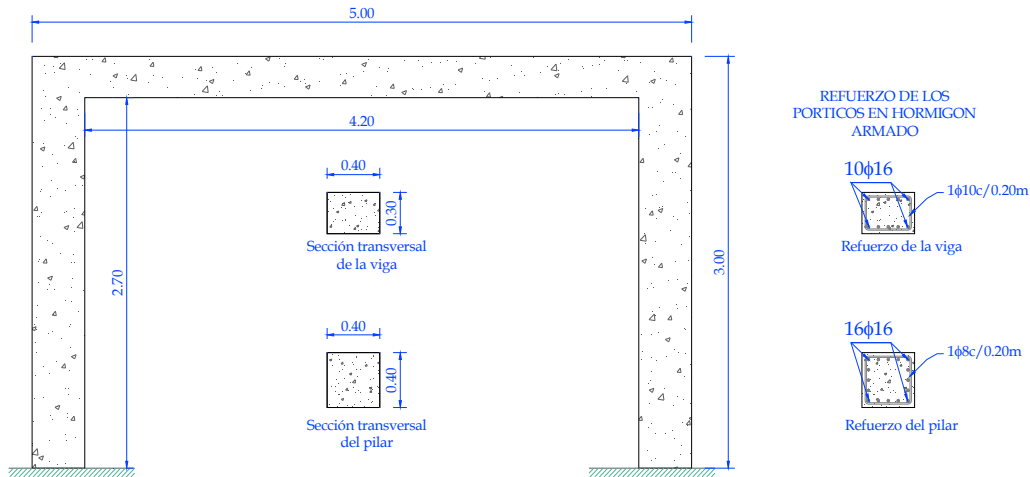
Geometría tipo de las estructuras porticadas [xliv]
